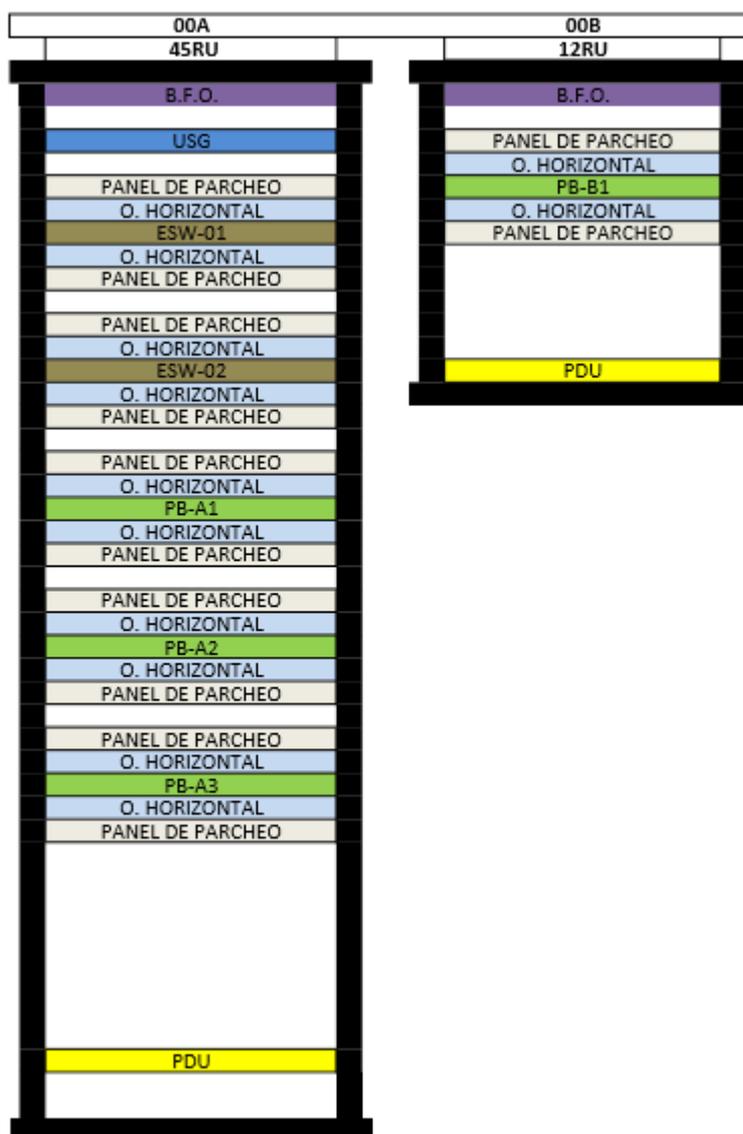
Elementos que conforman los rack – Planta Baja.
